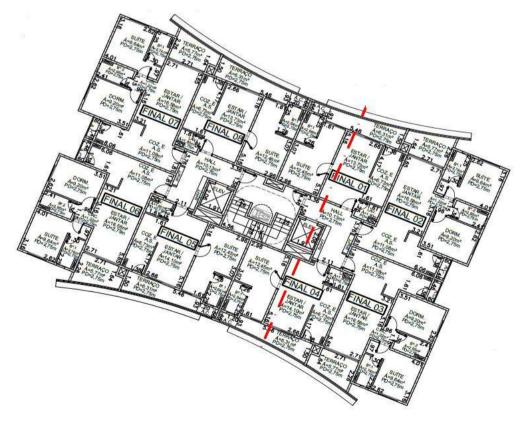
Projeto - Pavimento Tipo. Torres 7 e 8.
